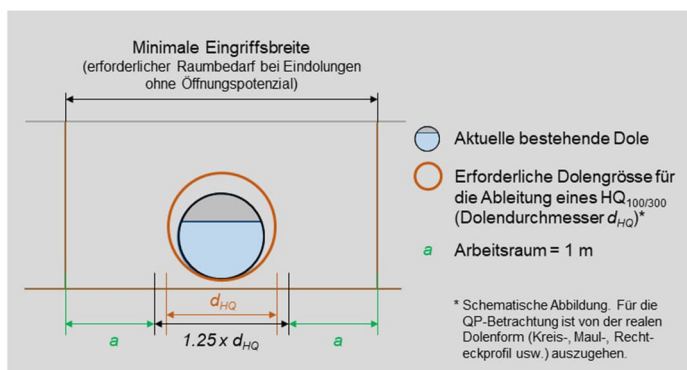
Querprofilbetrachtung für Dolen und überdeckte Hochwasserentlastungskanäle (Quelle: [www.gewaesserraum.ch](http://www.gewaesserraum.ch))
